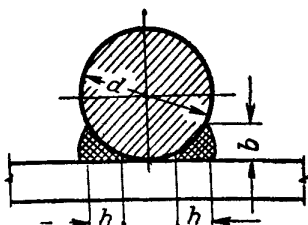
Размеры сварных фланговых швов при соединении гладких стержней и стержней периодического профиля с листовым и сортовым прокатом
